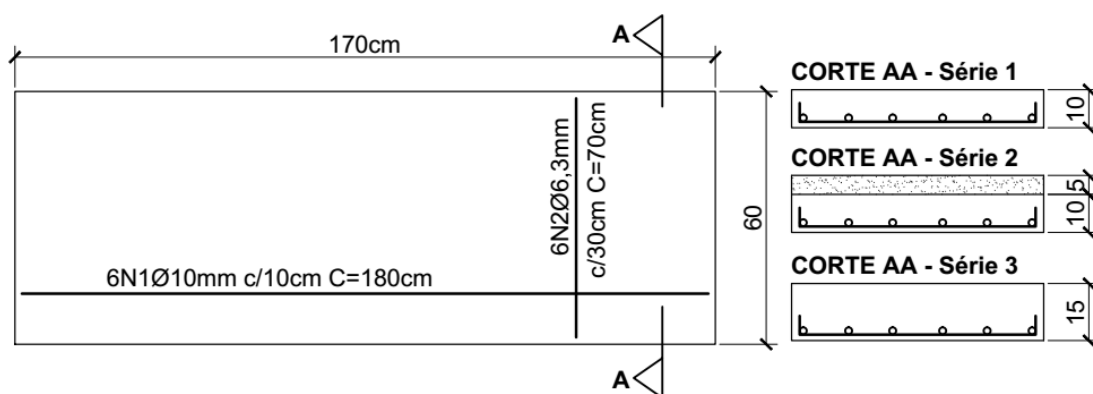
Detalhamento das lajes ensaiadas (PIRES, 2003).
